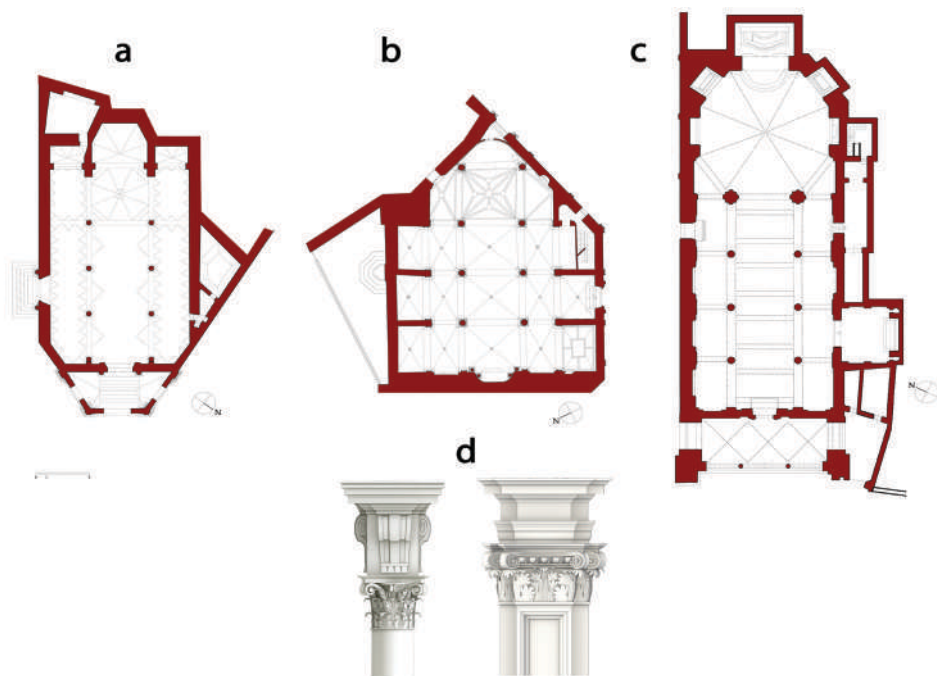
a) Pianta della chiesa di San Giovanni Battista della Nazione napoletana; b) pianta della chiesa di Santa Maria di Portosalvo; c) pianta della chiesa di Santa Maria La Nova; d) particolari di capitelli sormontati da frammenti di trabeazione: (a sinistra) particolare della chiesa San Giovanni Battista della Nazione napoletana; (a destra) particolare della chiesa di Santa Maria di Portosalvo (elaborazione grafica di Laura Barrale)
